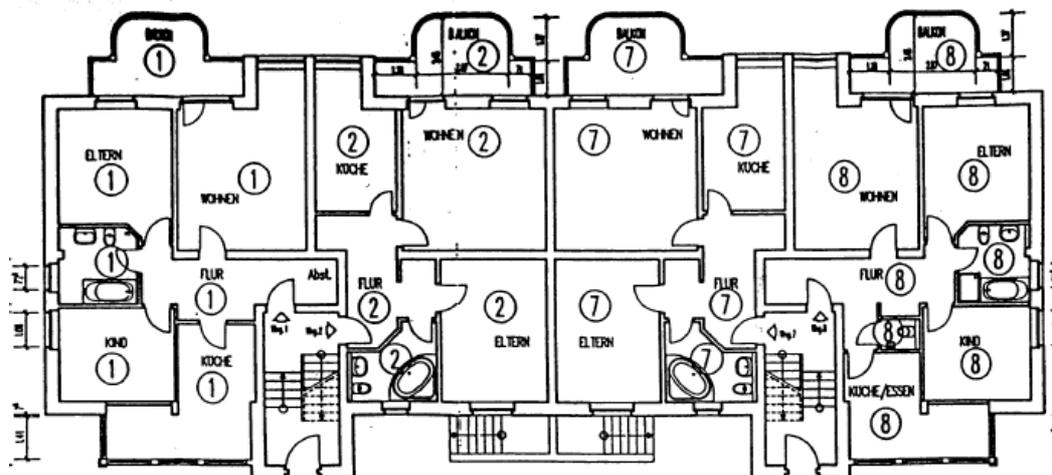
Grundriss EG, Planausschnitt o.M.
